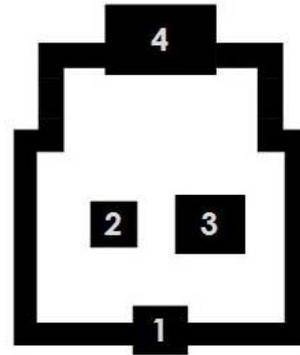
, Grundriss nach der Erweiterung des Umganges
